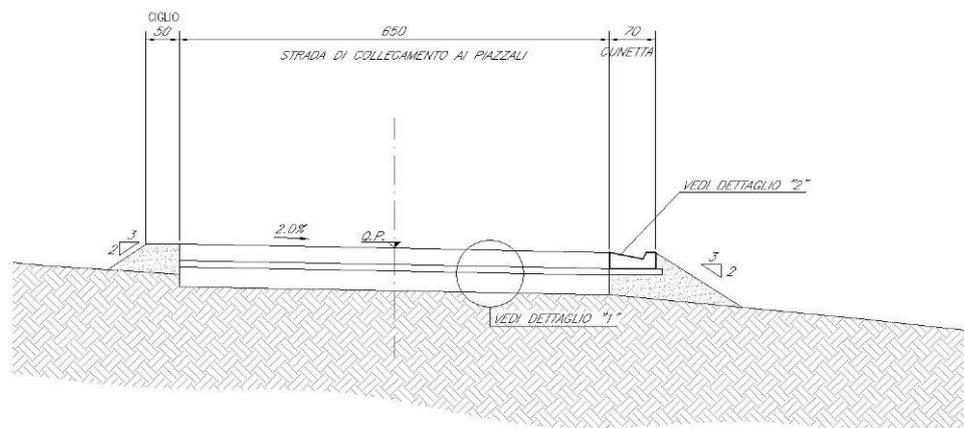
Stralcio sezione tipo viabilità di cantiere
